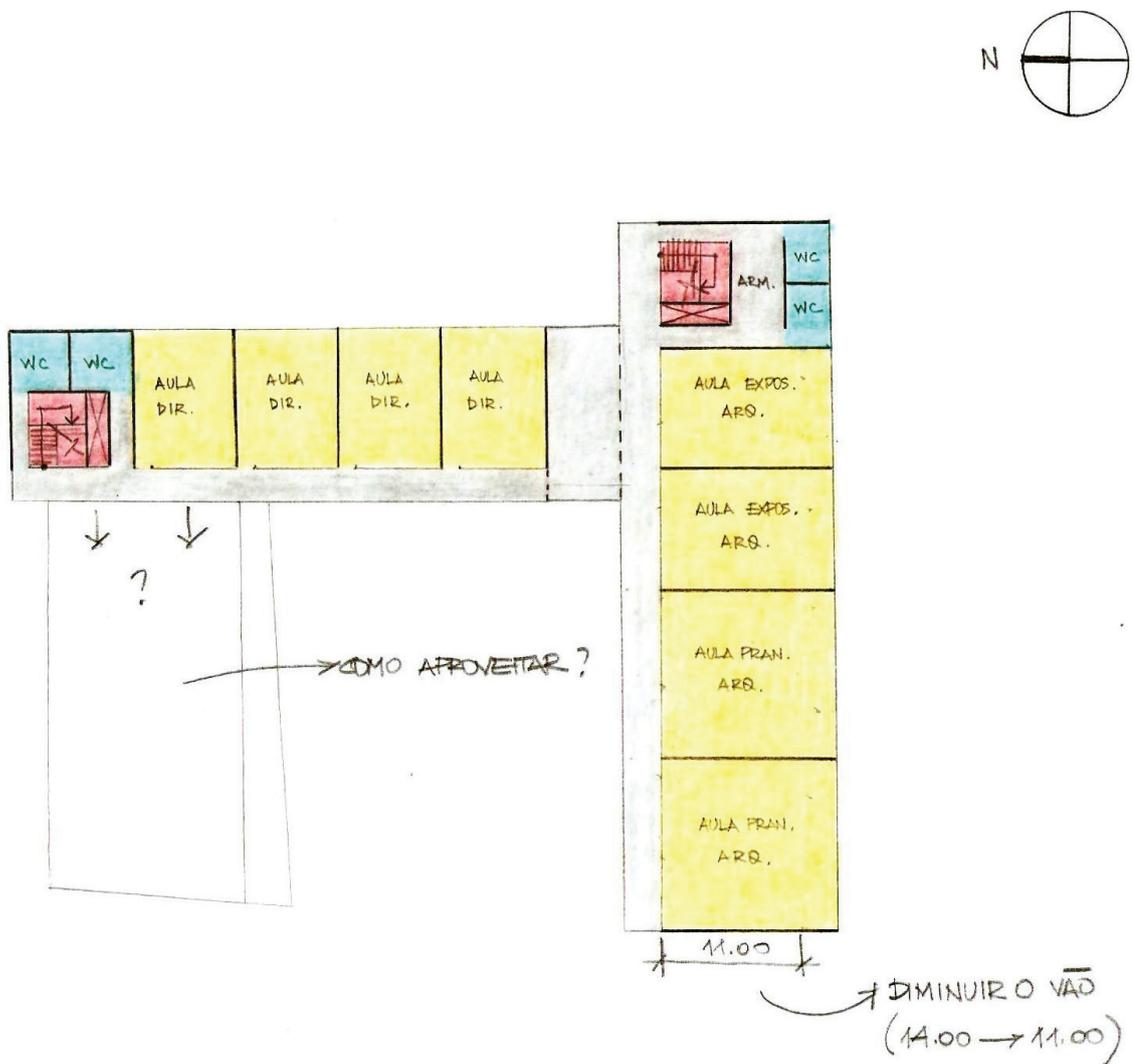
Proposta 4, estudo preliminar, Planta do 3º Pavimento
